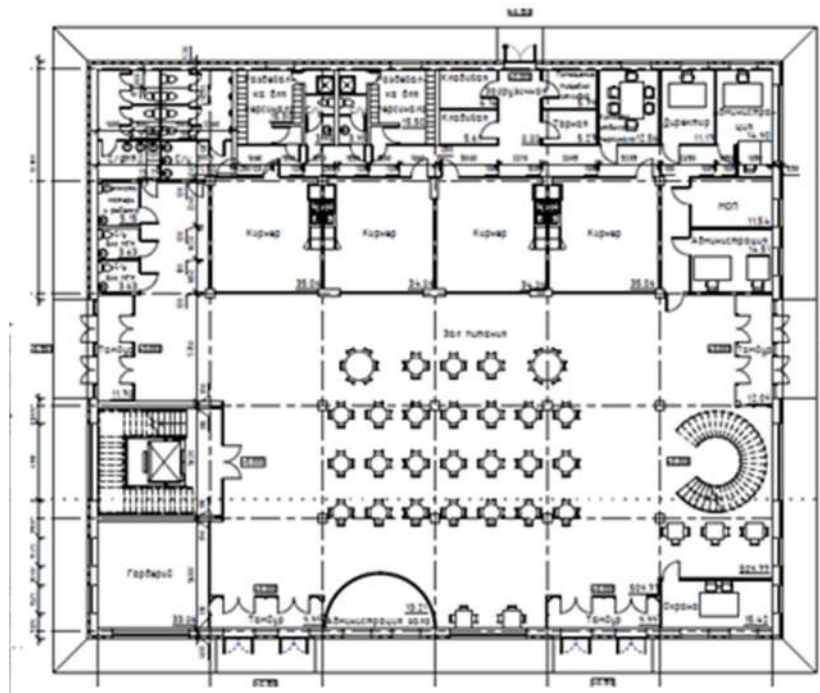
Проектные решения зданий с зальной планировочной схемой.
